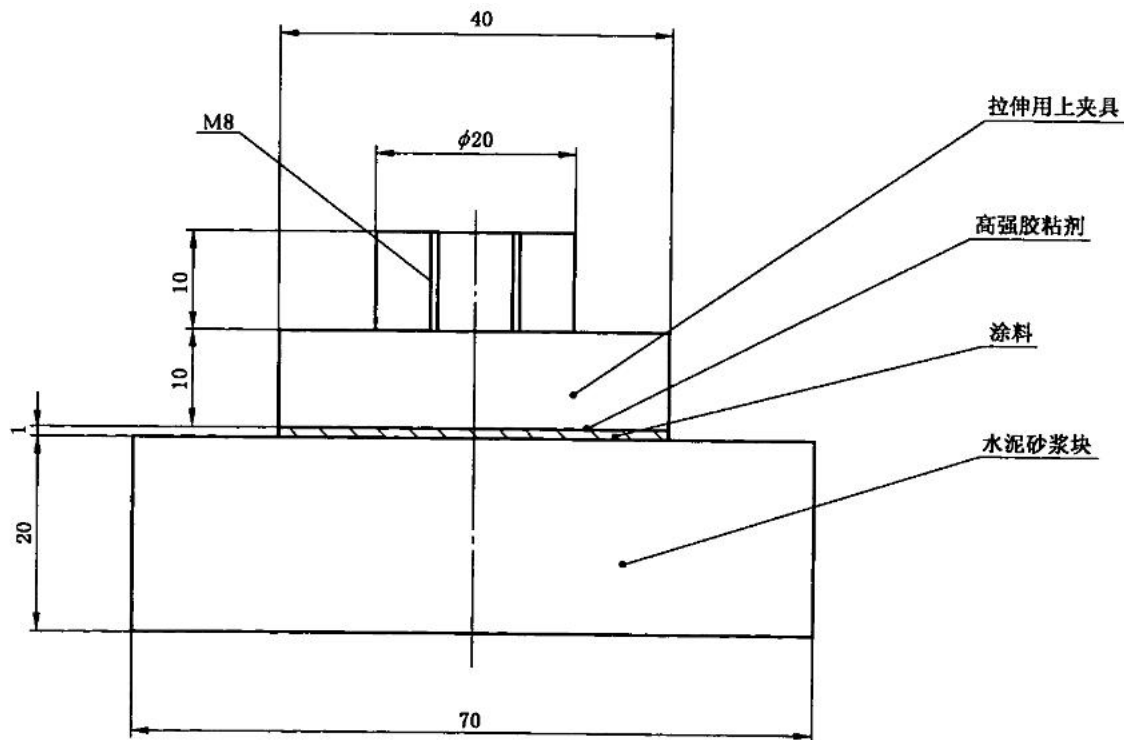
3-1 喷涂防水材料位置示意图 (单位: mm)
